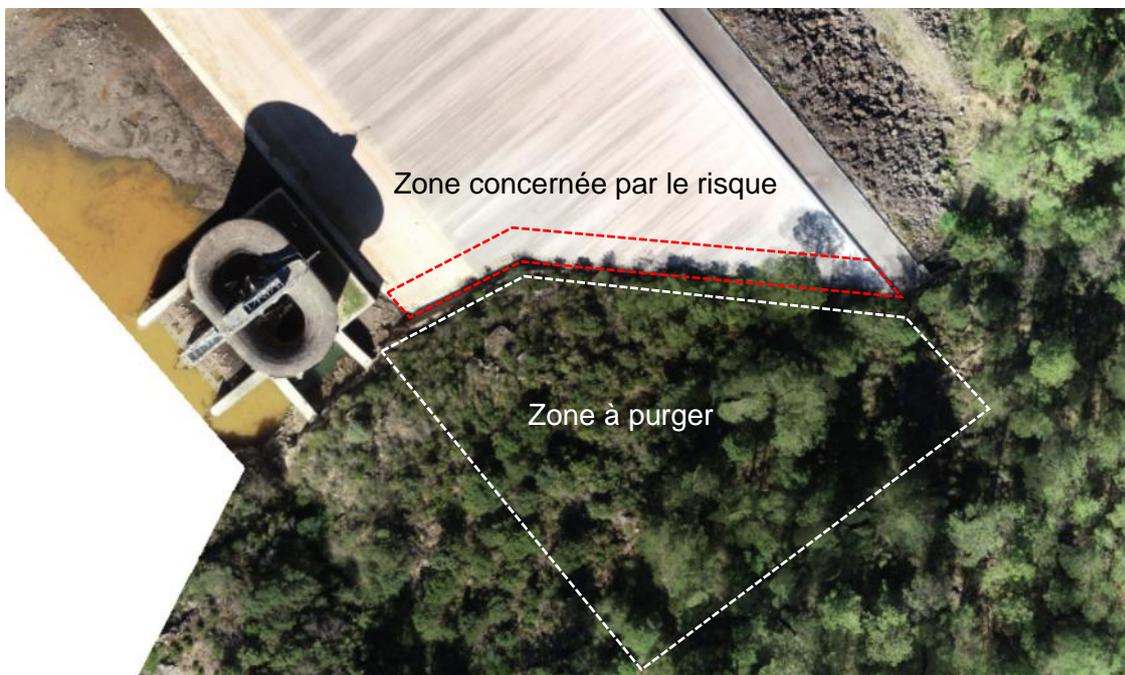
Zone de purge nécessaire à la protection de l'étanchéité amont
